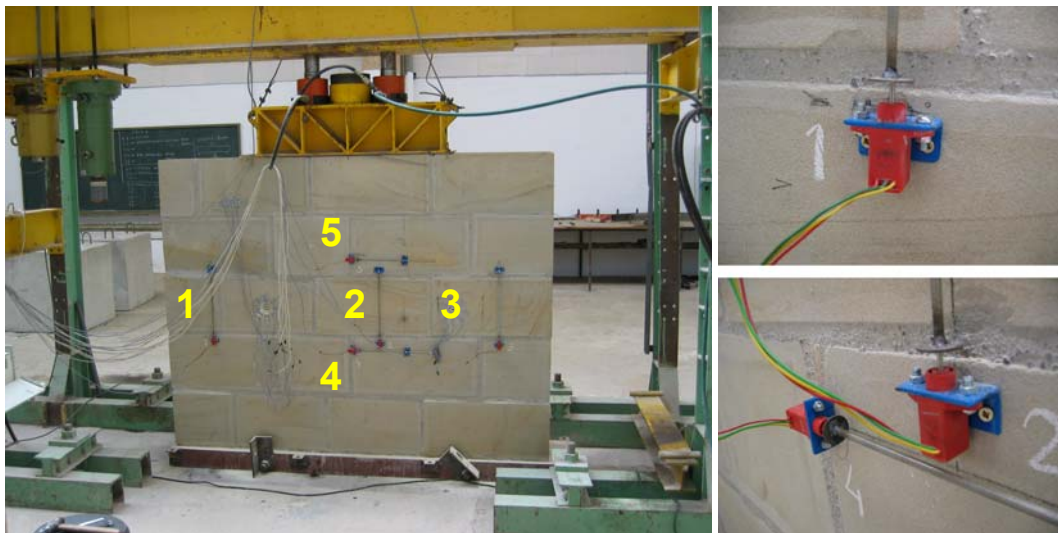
Ubicación de los transductores dentro del alzado del muro.
